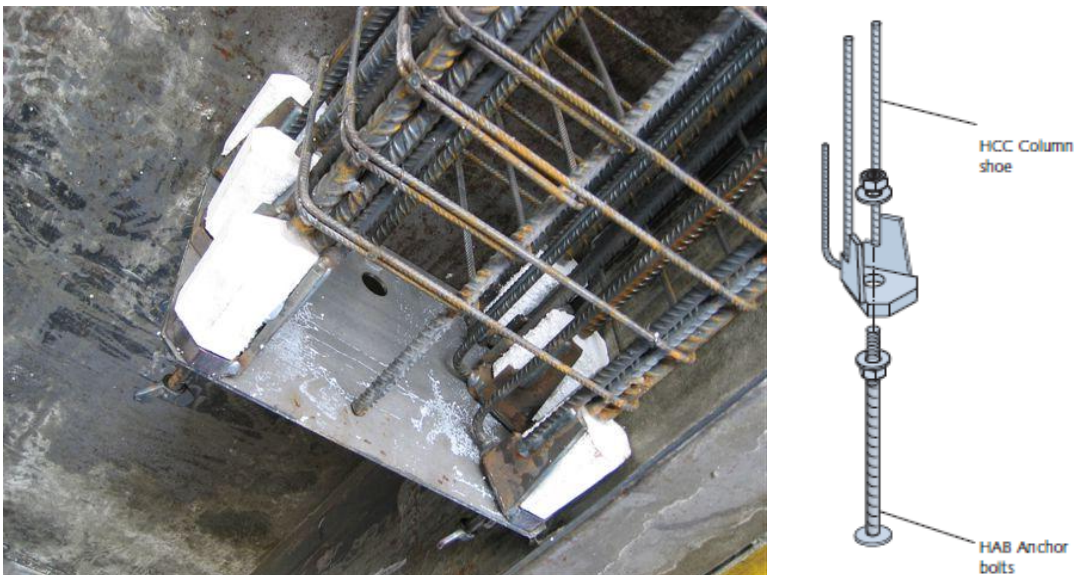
Esempio di armatura della pilastro prima del getto e particolare del collegamento tra scarpa e tirafondo[www.halfen.com]
